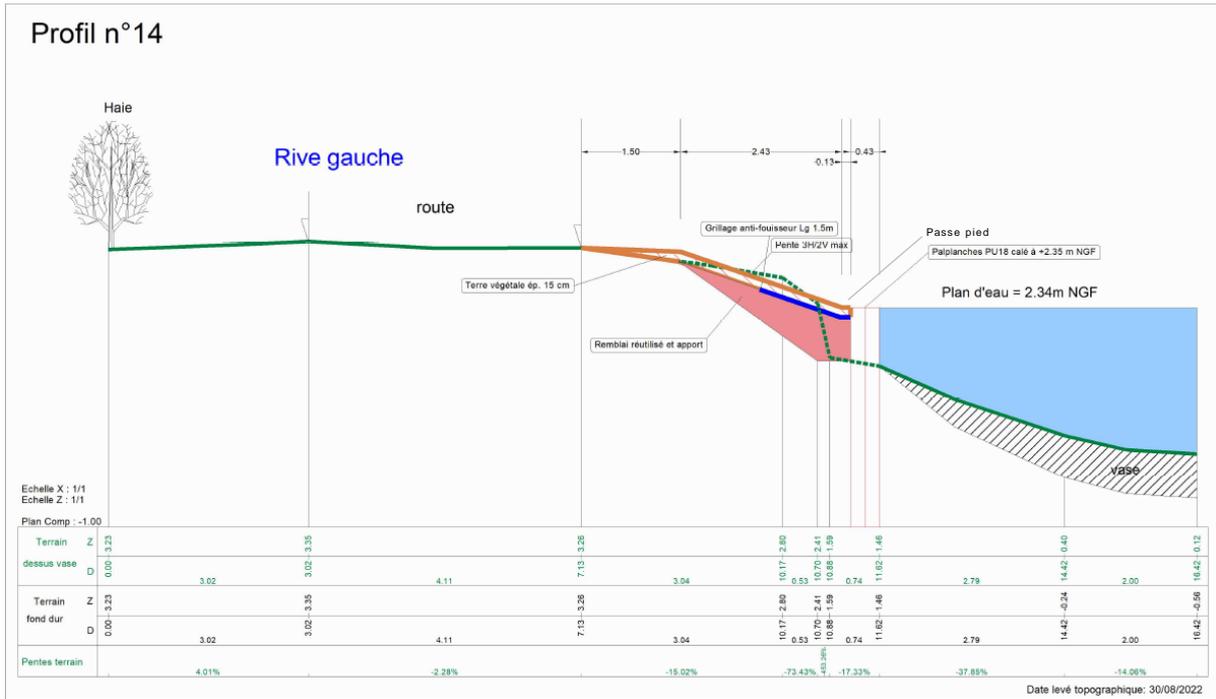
Exemple d'un profil en travers aménagé par des palplanches sur la zone 1.1.1.
